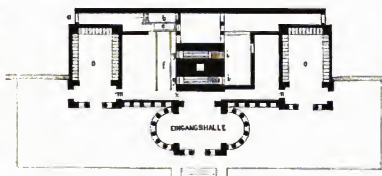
Verbrennungsofen. Grundriss.
